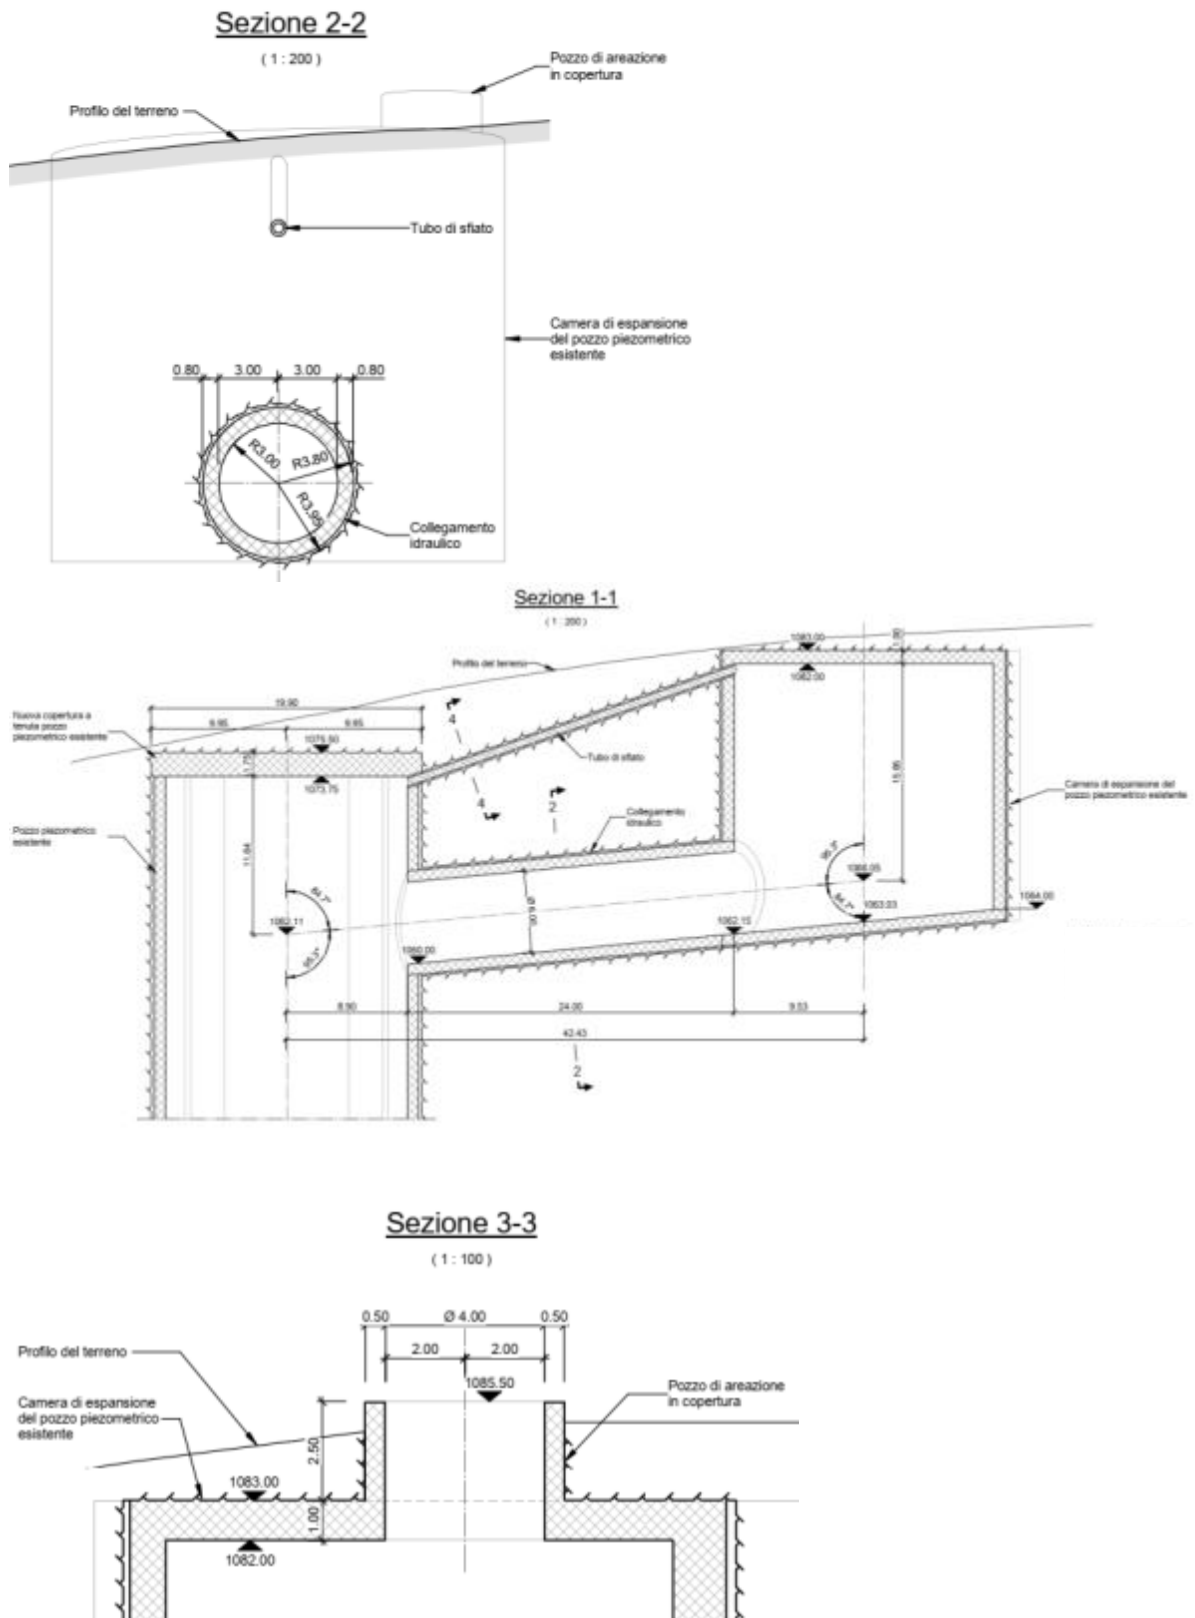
Nuova camera di espansione al pozzo piezometrico sulla derivazione Provvidenza – sezioni
